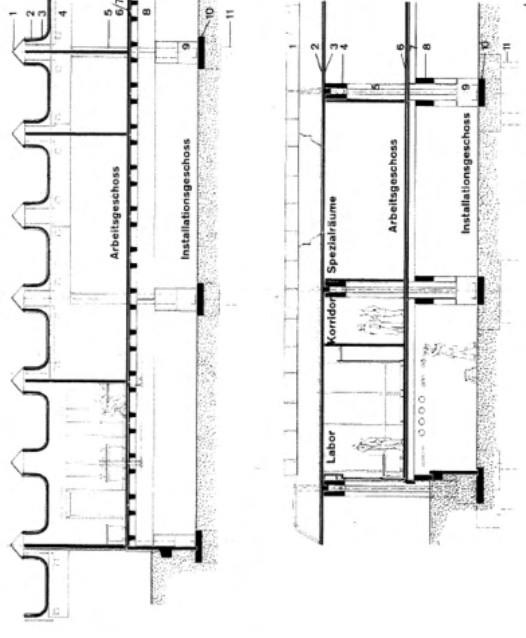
Coupes-type d'un bâtiment constitué de deux étages : un rez-de-chaussée surélevé et d'un sous-sol technique (source : SBC, Recensement d'architecture contemporaine, Rapport 2016).
